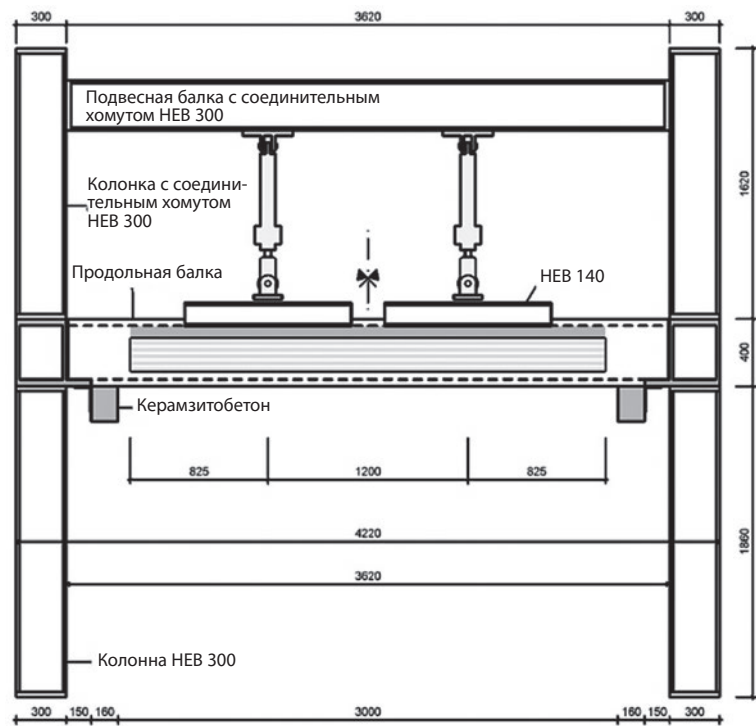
Испытательная установка для испытаний CLT-балок на изгиб
